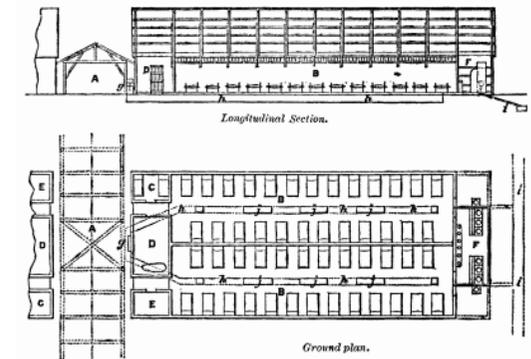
Planta y sección longitudinal del Hospital militar de Renkoi.
